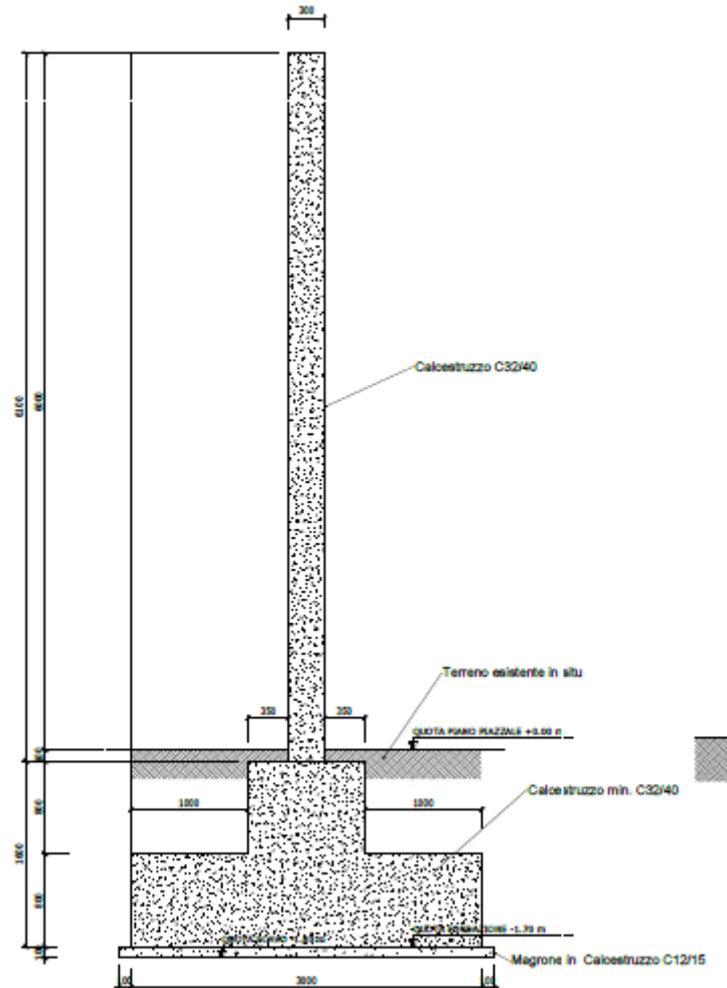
Sezione muro tagliafiamme (Fonte: stralcio elaborato 0120-03-DADB-13581\_EX-DE\_0 - CONNESSIONE RTN - Disegni tipologici fondazioni apparecchiature elettromeccaniche)
